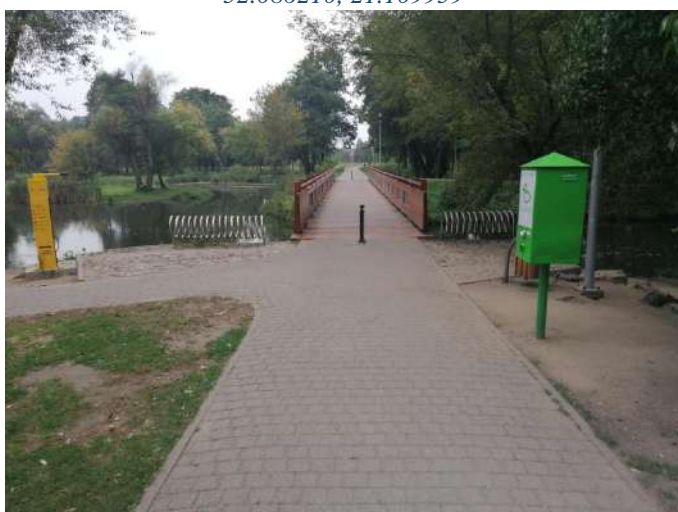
[w kierunku północno-zachodnim] Park Zdrojowy widok na most Parkowy na Jeziorce
